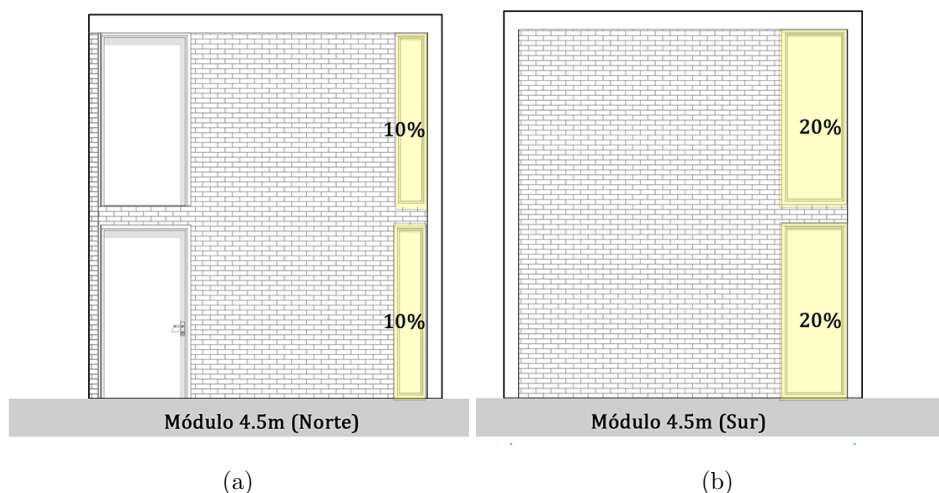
Superficie vidriada en cada fachada, (a) Módulo de 4.5m, fachada norte, (b) Módulo de 4.5m, fachada sur.
